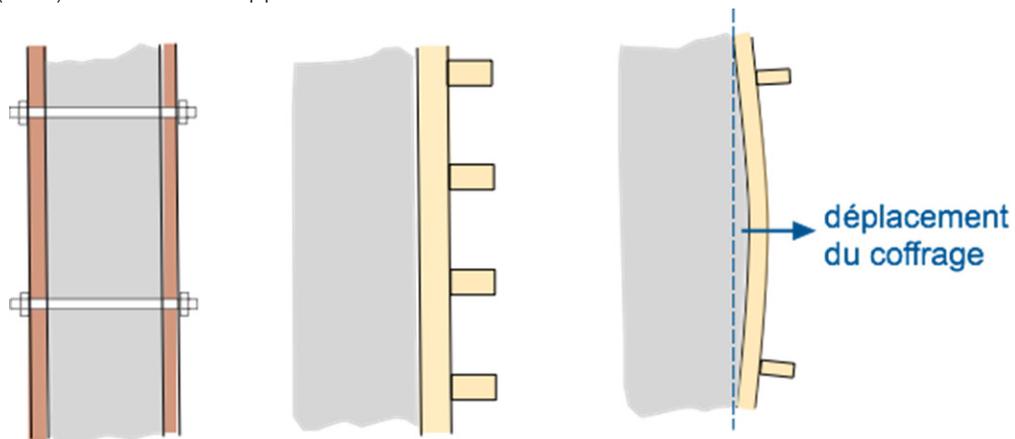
Rigidité et contreventement des coffrages⁽⁸⁾
